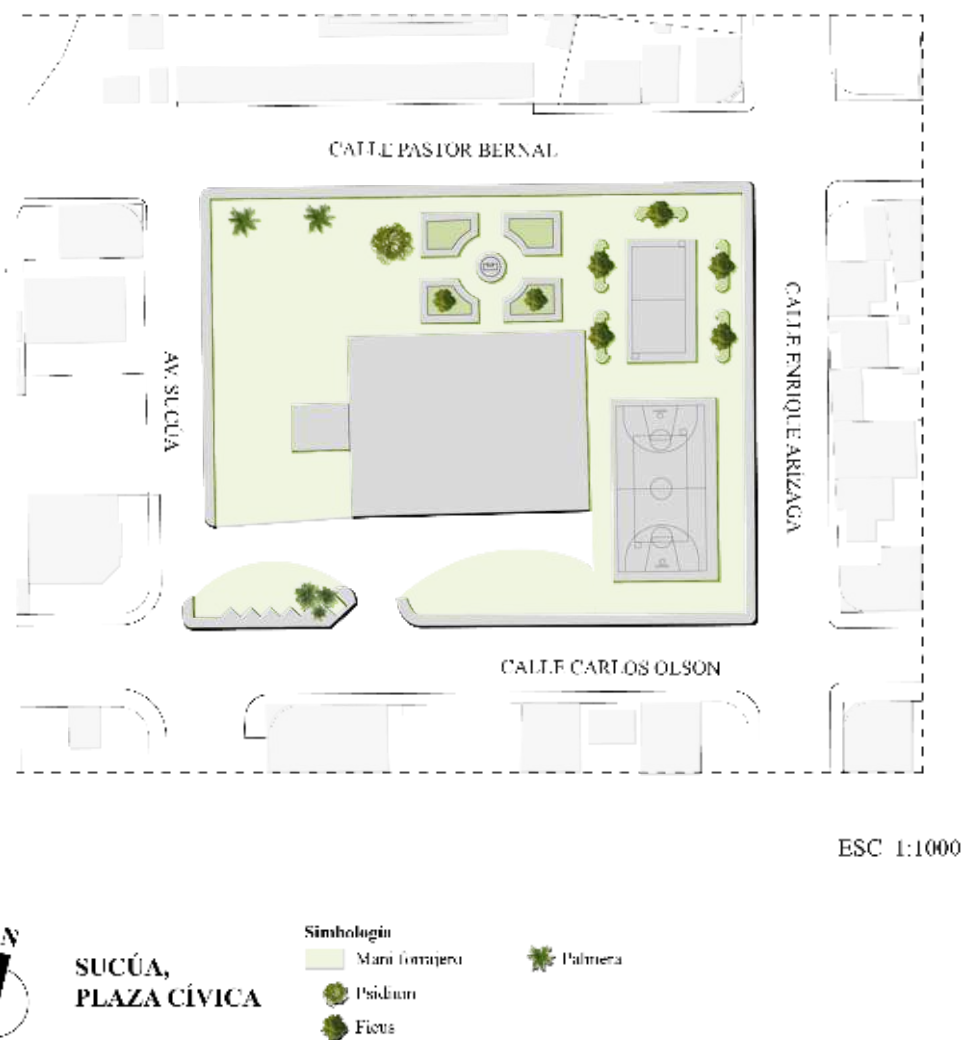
Plano de levantamiento de vegetación existente en la Plaza Cívica. Elaboración: propia
